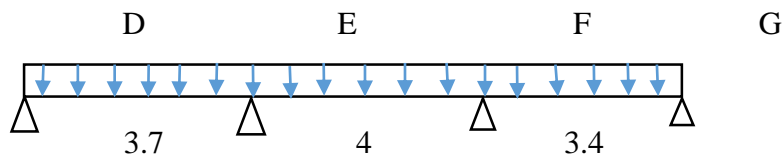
Schéma statique de la poutrelle à 3 travées.
